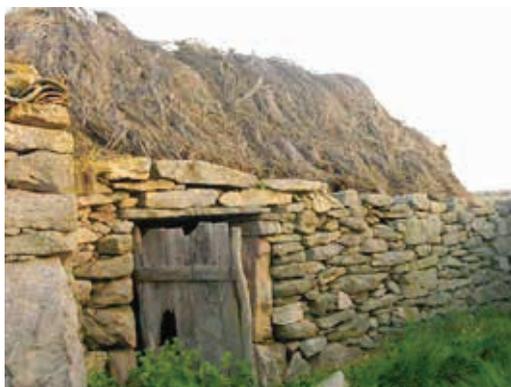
Fuente: Fco. Javier San Vicente; Arquitectura tradicional de La Ramajería.
